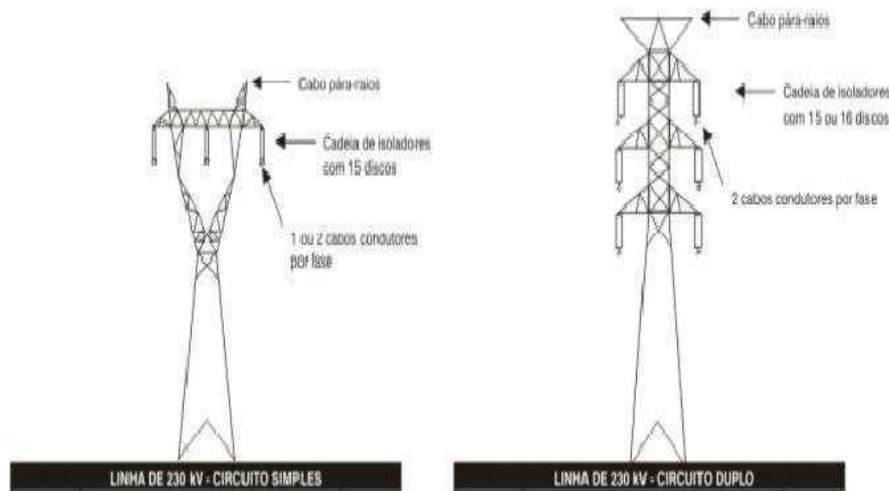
Ilustração de estruturas tipo suspensão (RANGEL, 2009)
